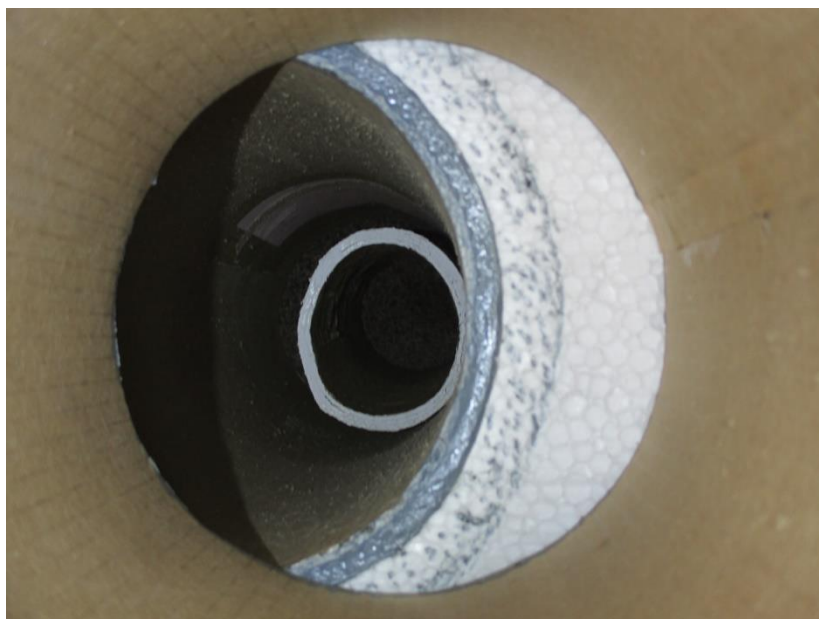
Situatie met alleen afschuiving, dus zonder tussenruimte (zie foto 4)
